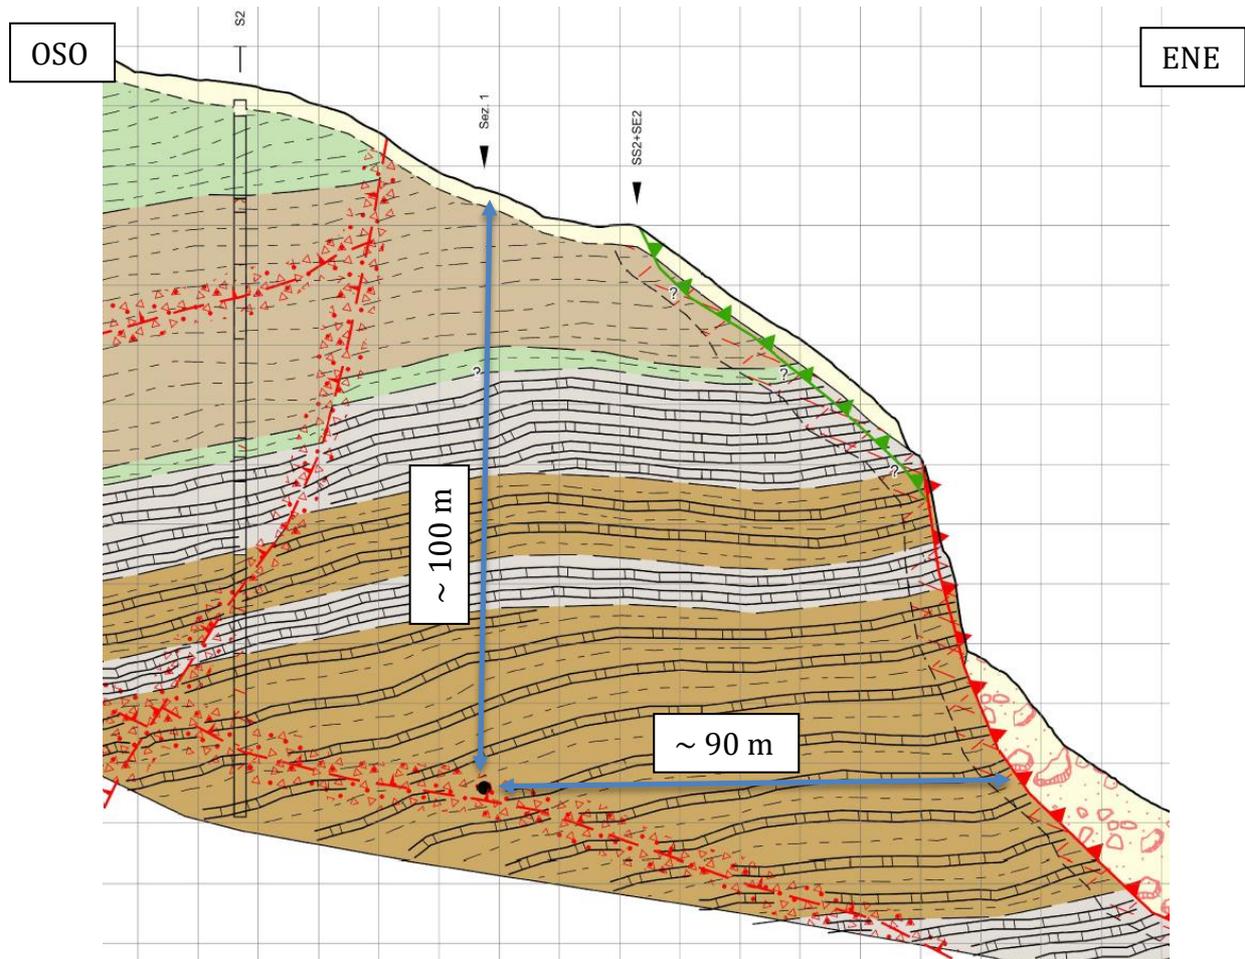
Stralcio della sezione geologica n. 3 di progetto in cui si comprende la posizione in profondità della galleria di variante (punto nero) rispetto alla superficie di scivolamento della frana del 2017/2018
